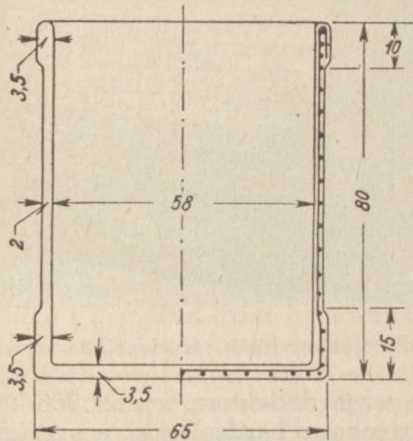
Wykonanie beczki żelbetowej w sposób obrotowy.
